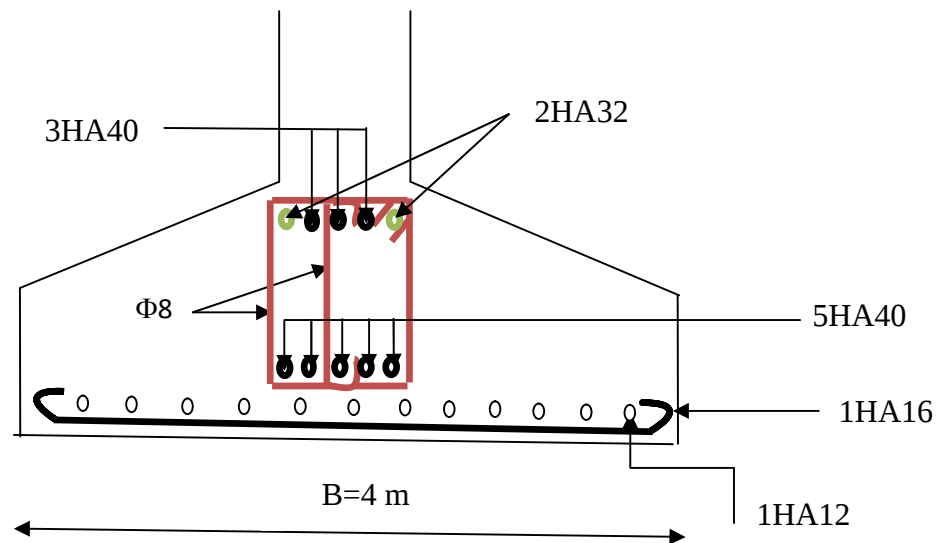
Schéma de ferrailage de la semelle filantes dans le sens // B.
